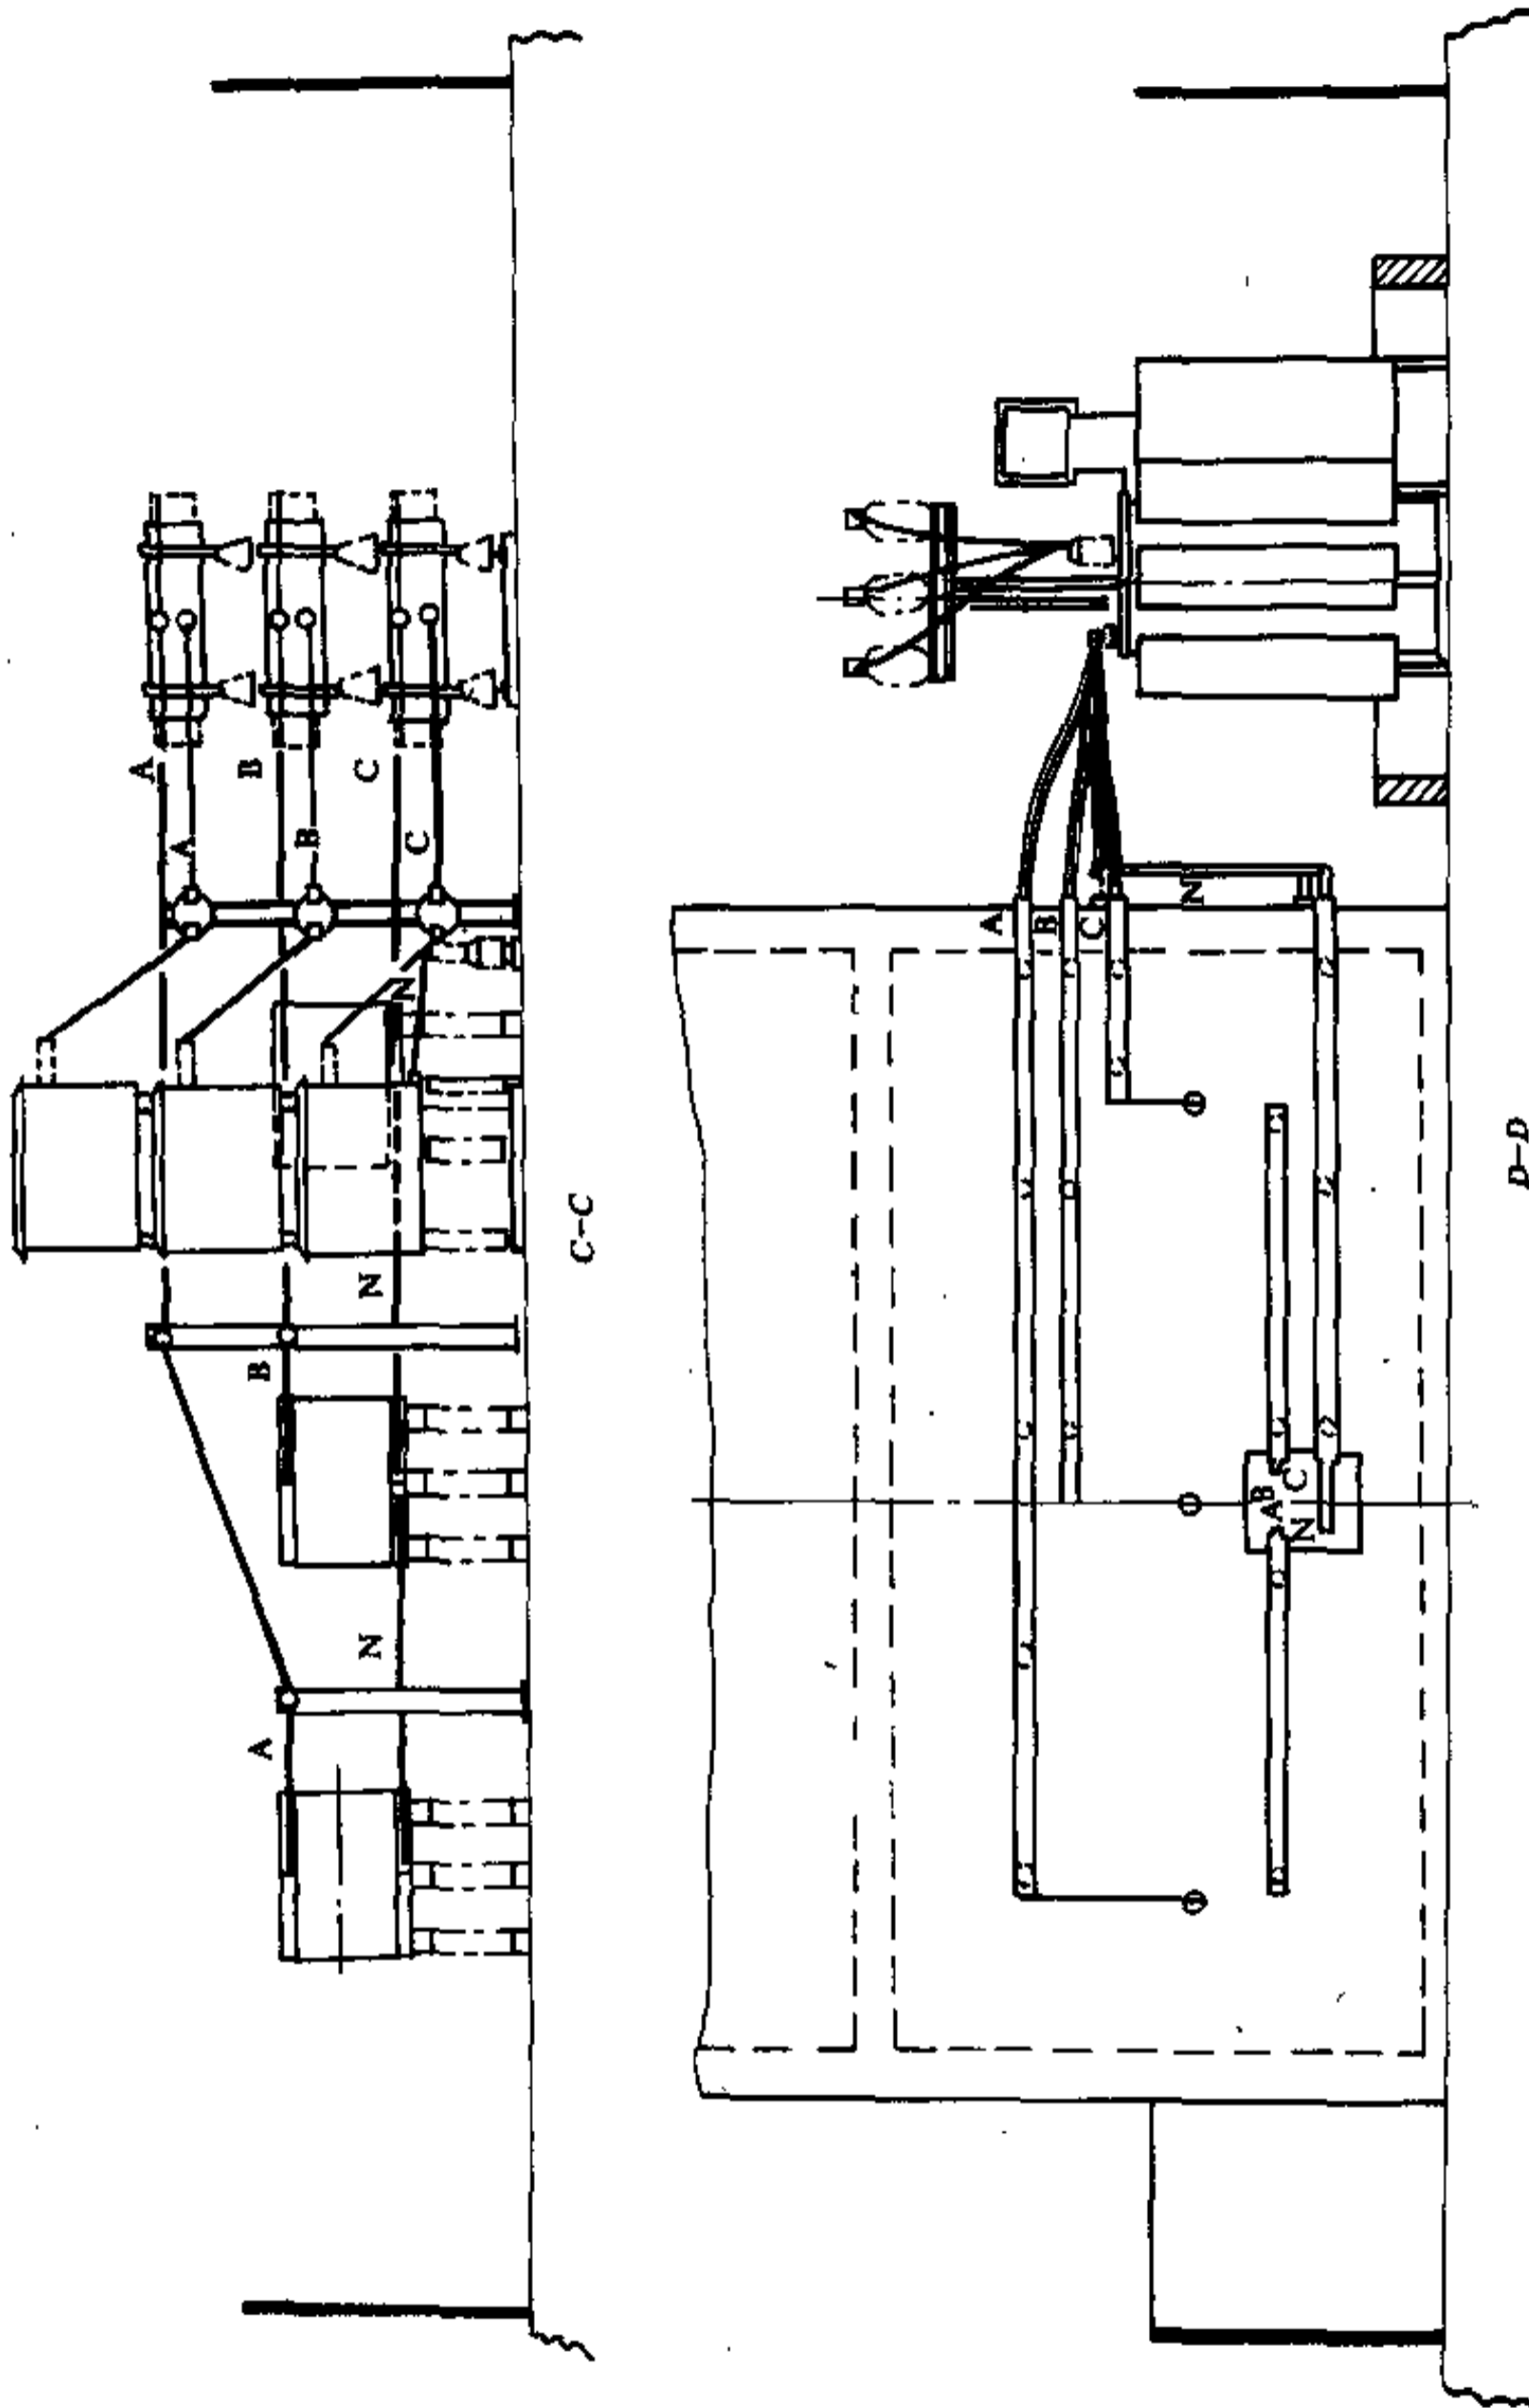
某工程 TCR 型静止补偿器剖面图 (二)
